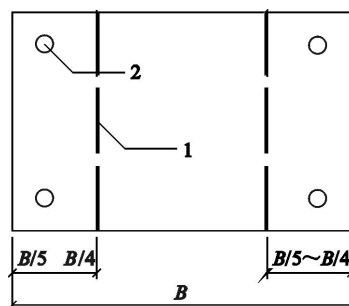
预制钢筋混凝土空调板支撑平面布置
